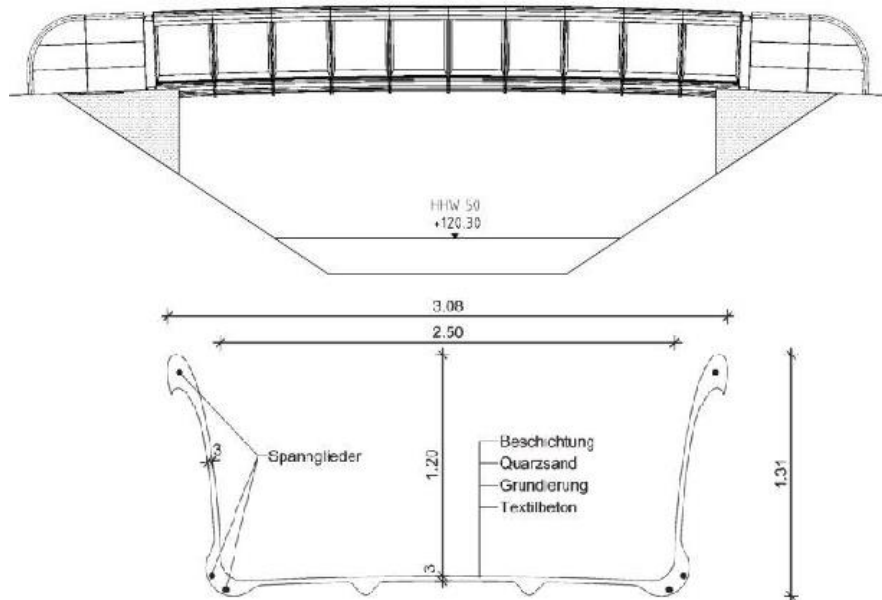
Vista lateral da passarela de concreto têxtil e sua seção transversal
